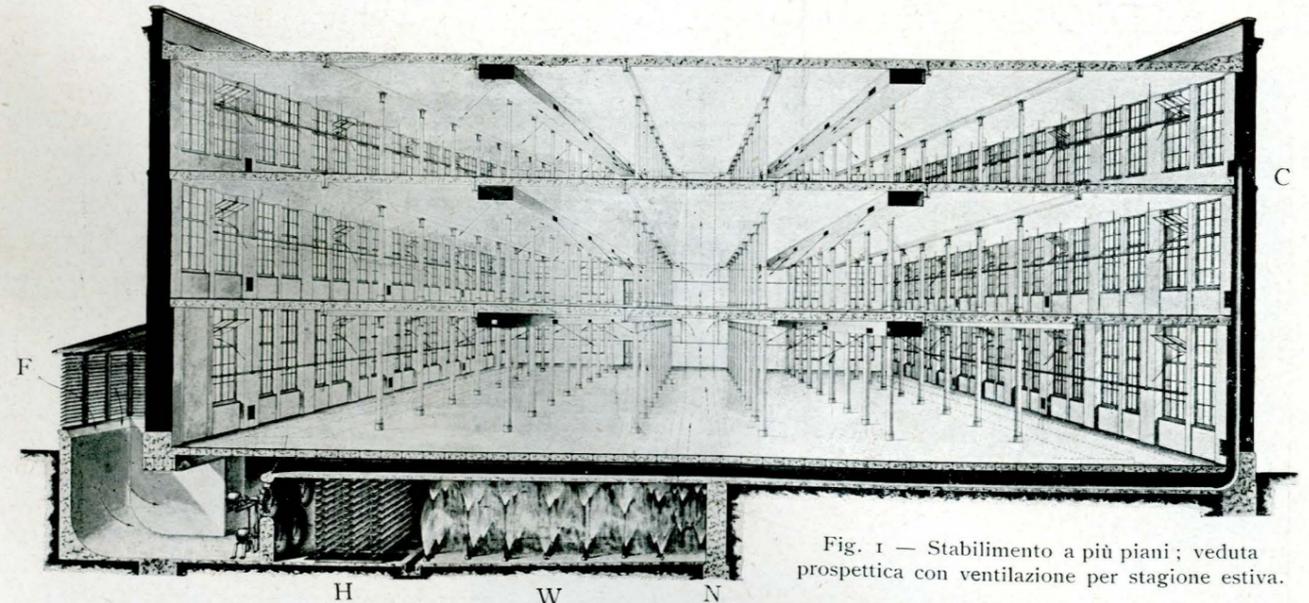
Stabilimento a più piani; veduta prospettica con ventilazione per stagione estiva.
